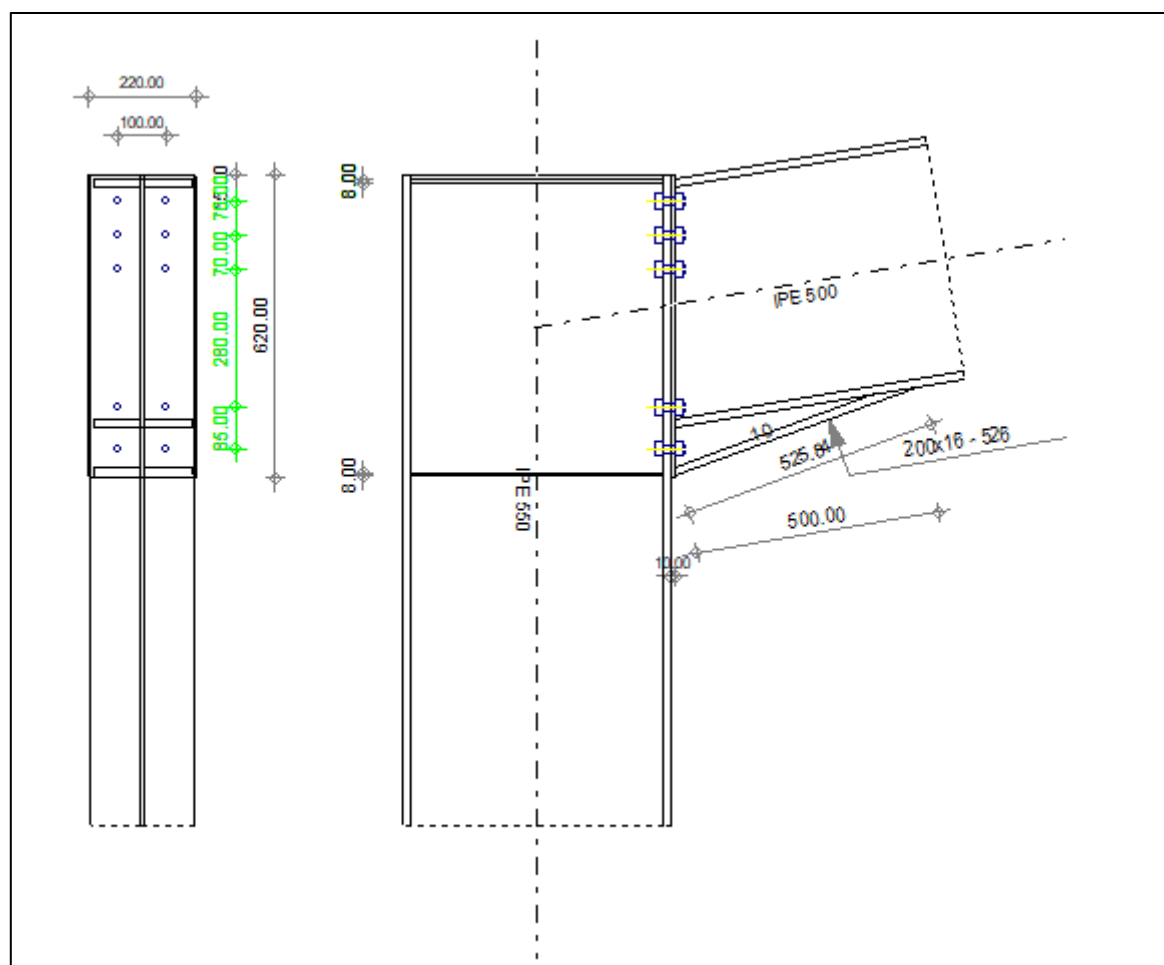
Schéma de l'assemblage poteau-poutre.
